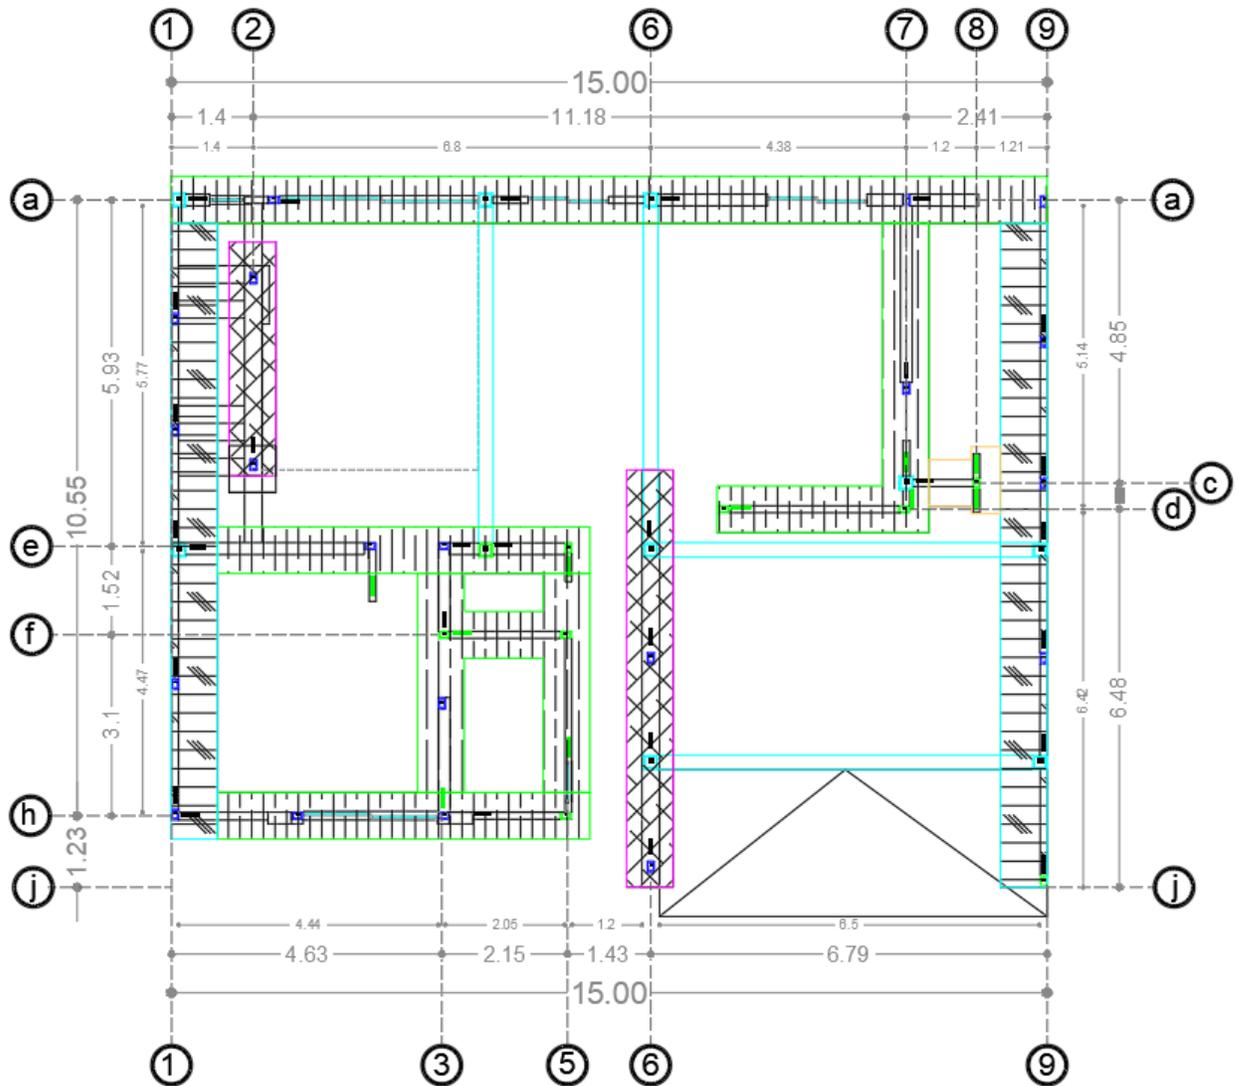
Plano de Cimentación (Muciño, 2022) (Zapatas corridas de mampostería de piedra).
